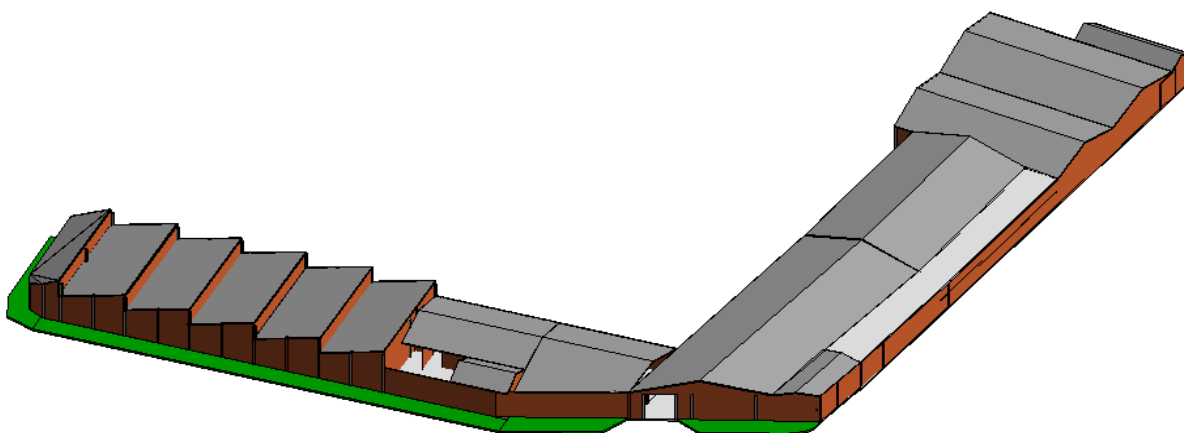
Esquema de la planta de producción de la empresa manufacturera de embragues
